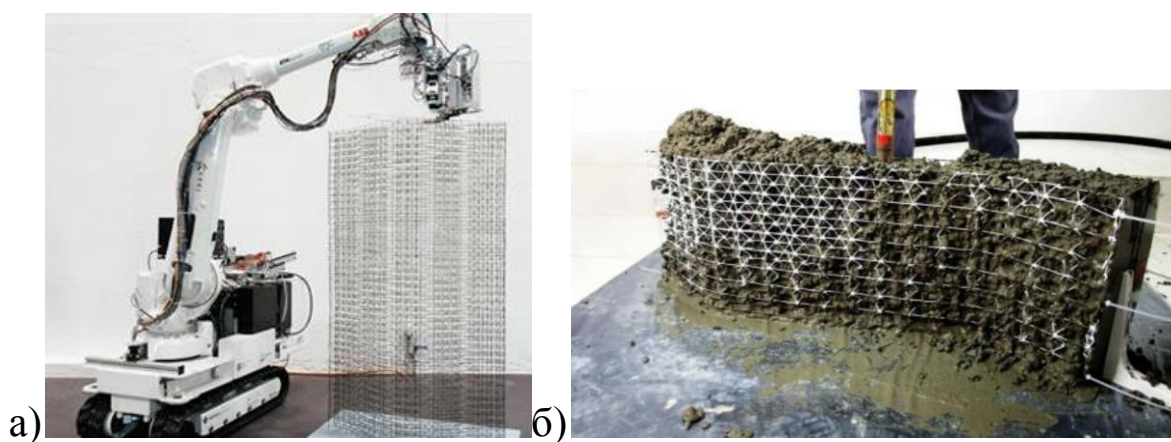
Проект Mesh Mould: а – создание стального арматурного каркаса [2]; б – процесс укладки бетонной смеси [3]
